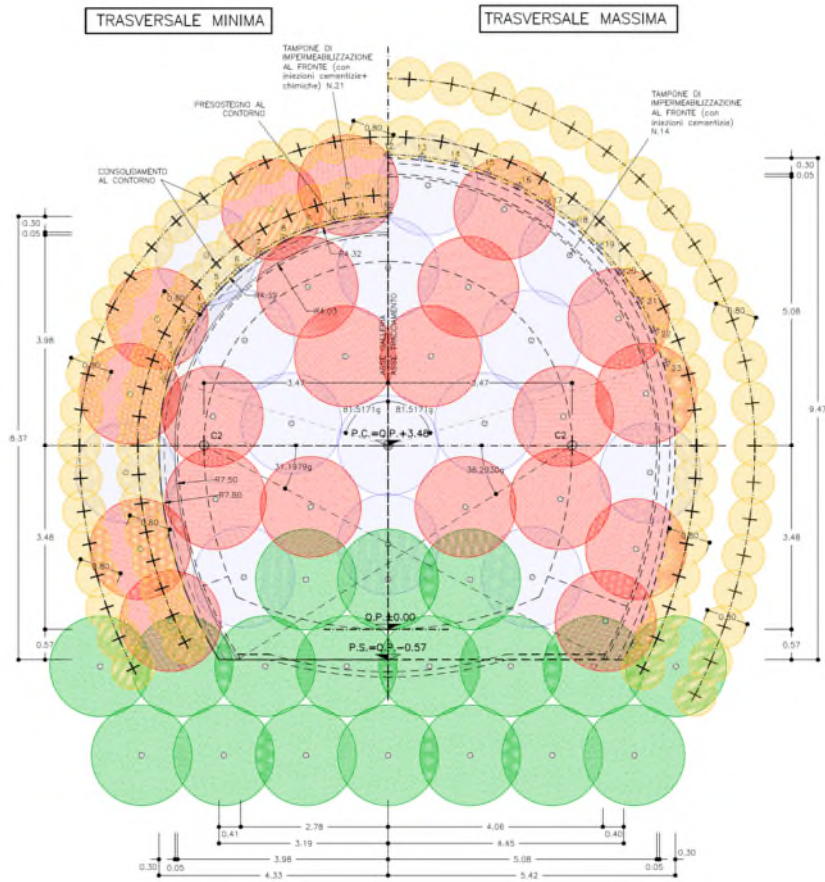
Sezione Tipo C1P – Scavi e consolidamenti - Sezione
